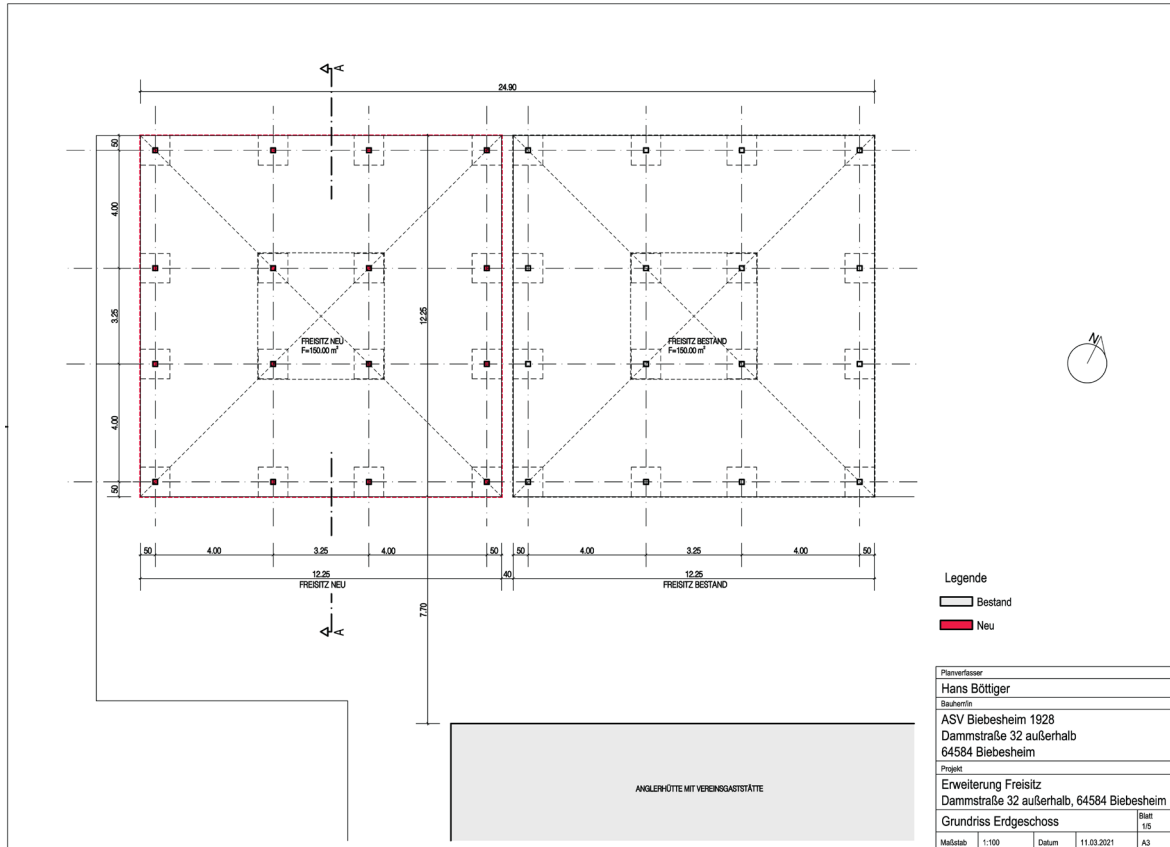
Grundriss Erdgeschoss, Quelle: Architekt Hans Böttiger
